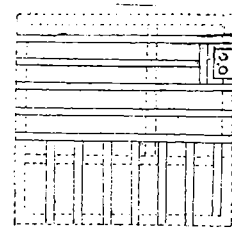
Grindă sprijinită pe lemn ieșit afară din zid
